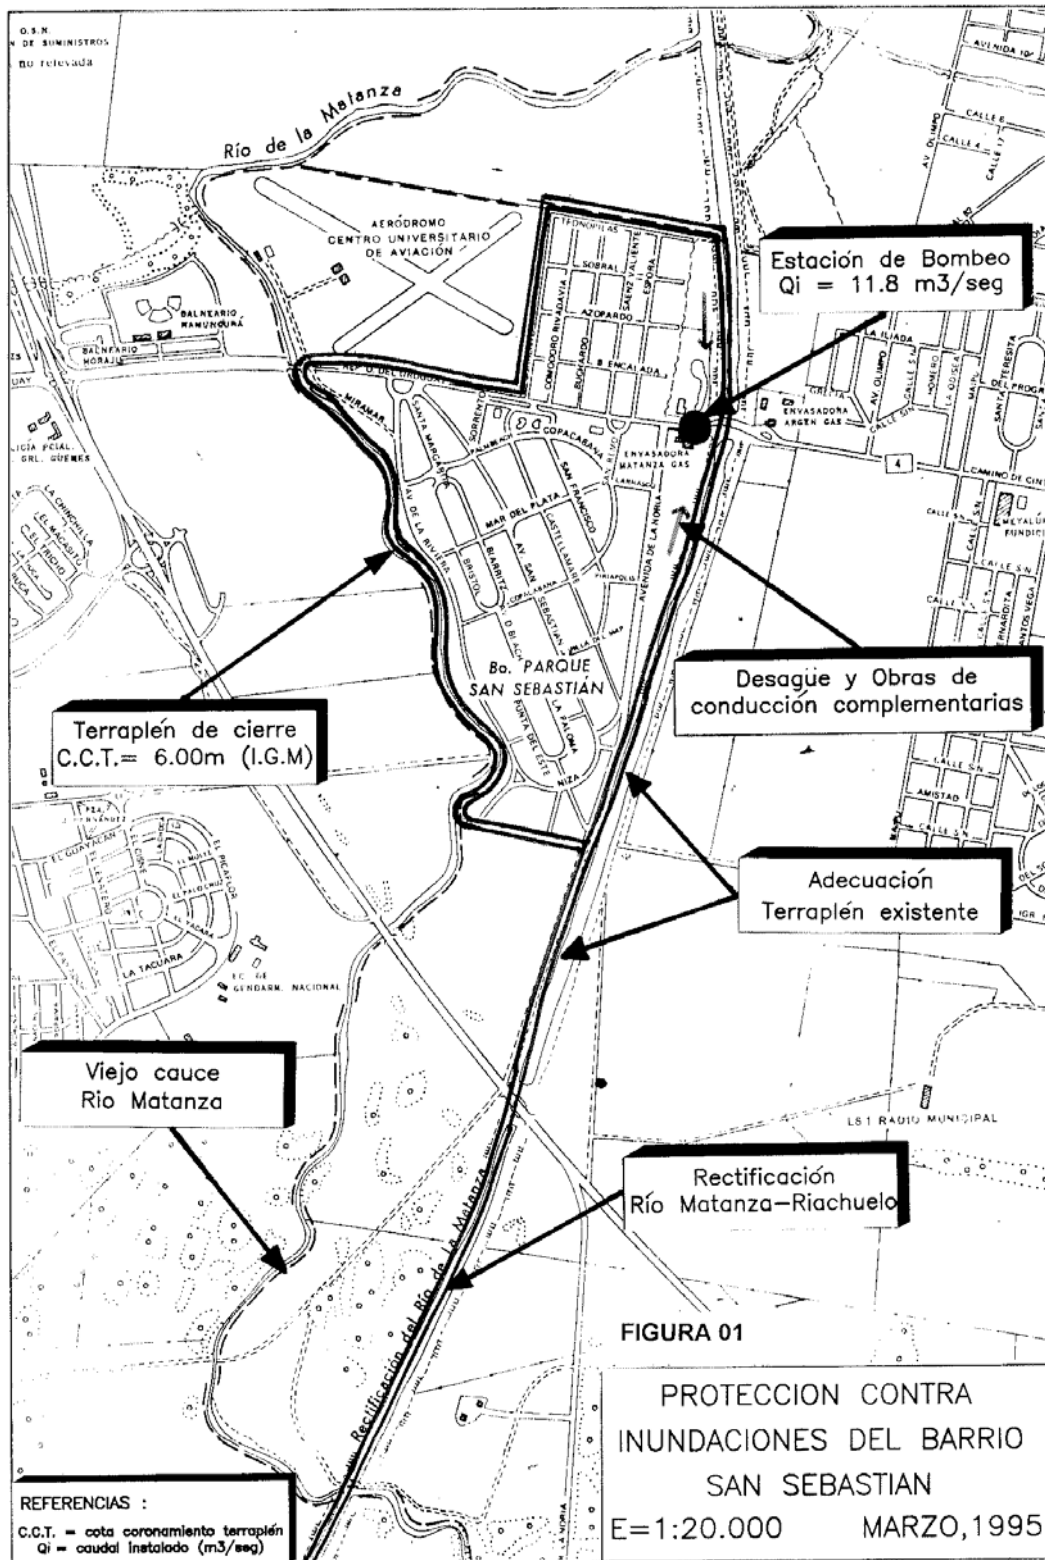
Protección contra inundaciones del Barrio San Sebastián previsto según el Plan de 1994
